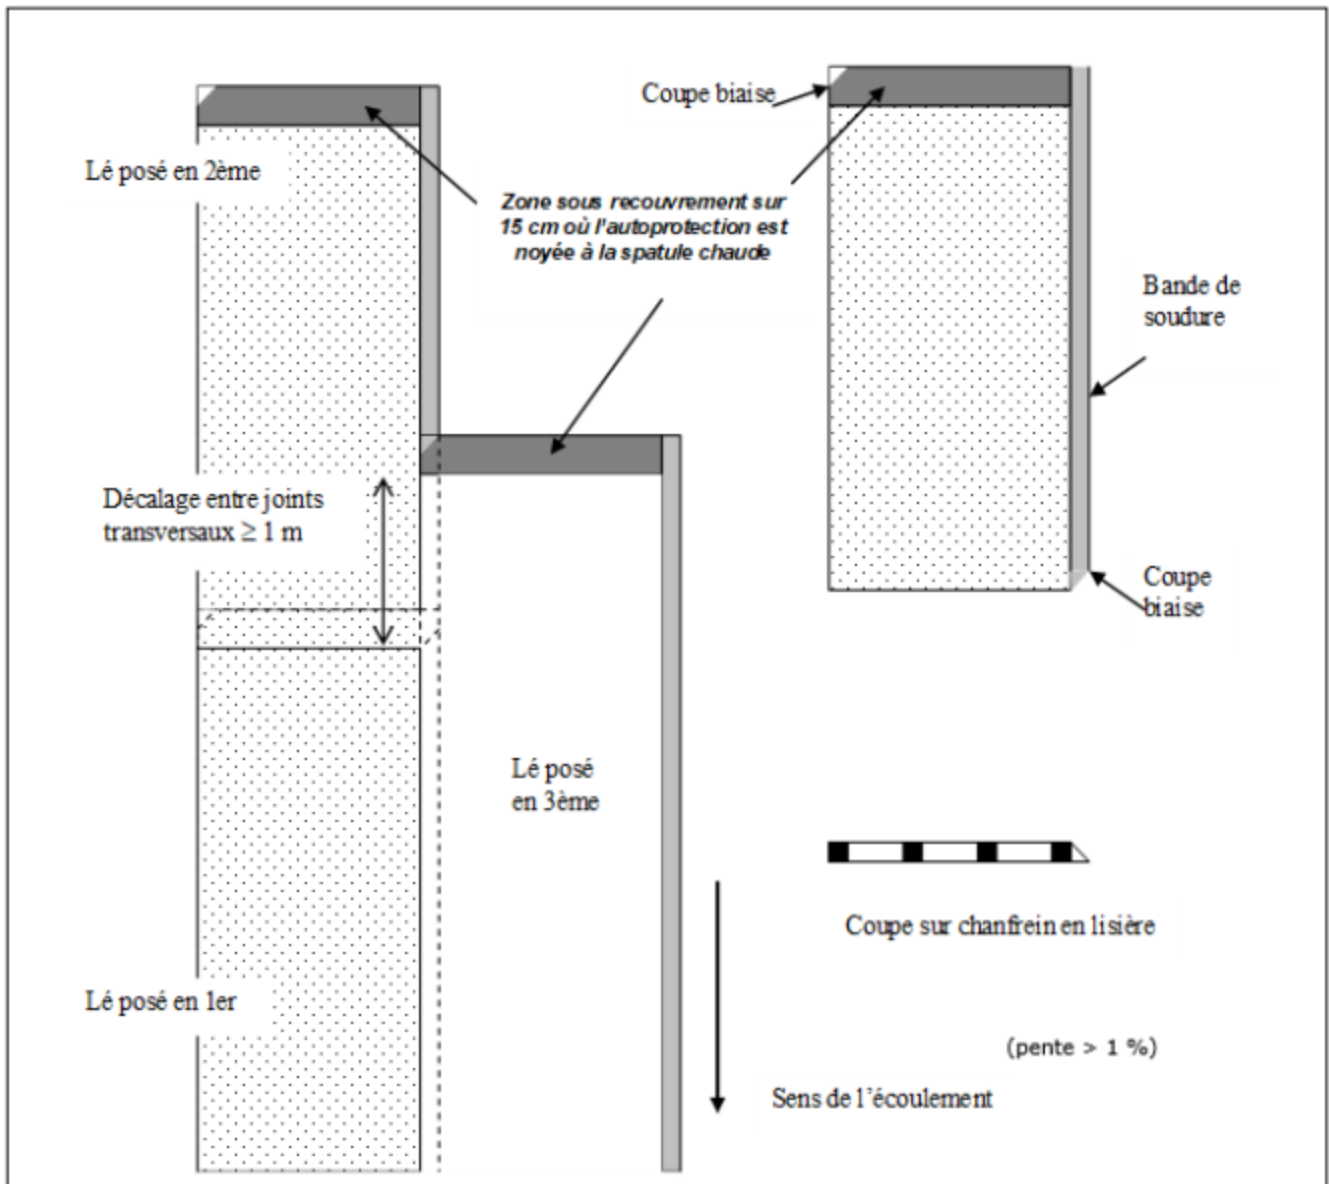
Jonctions soudées pour revêtement monocouche (pente > 1 %)
